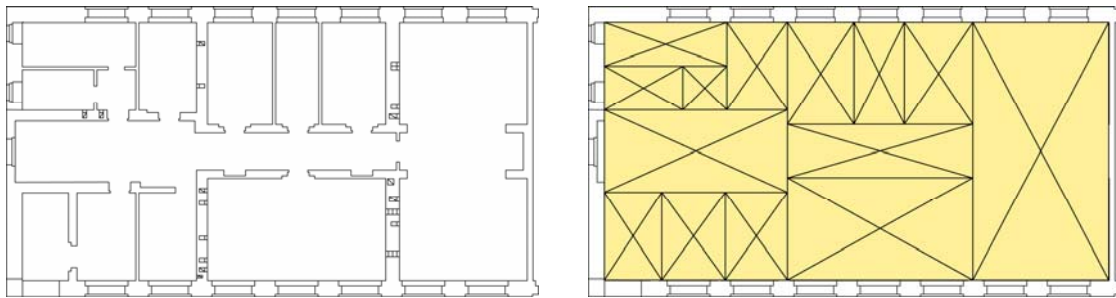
Grundrissabstraktion – Zerlegung in rechteckige Units
